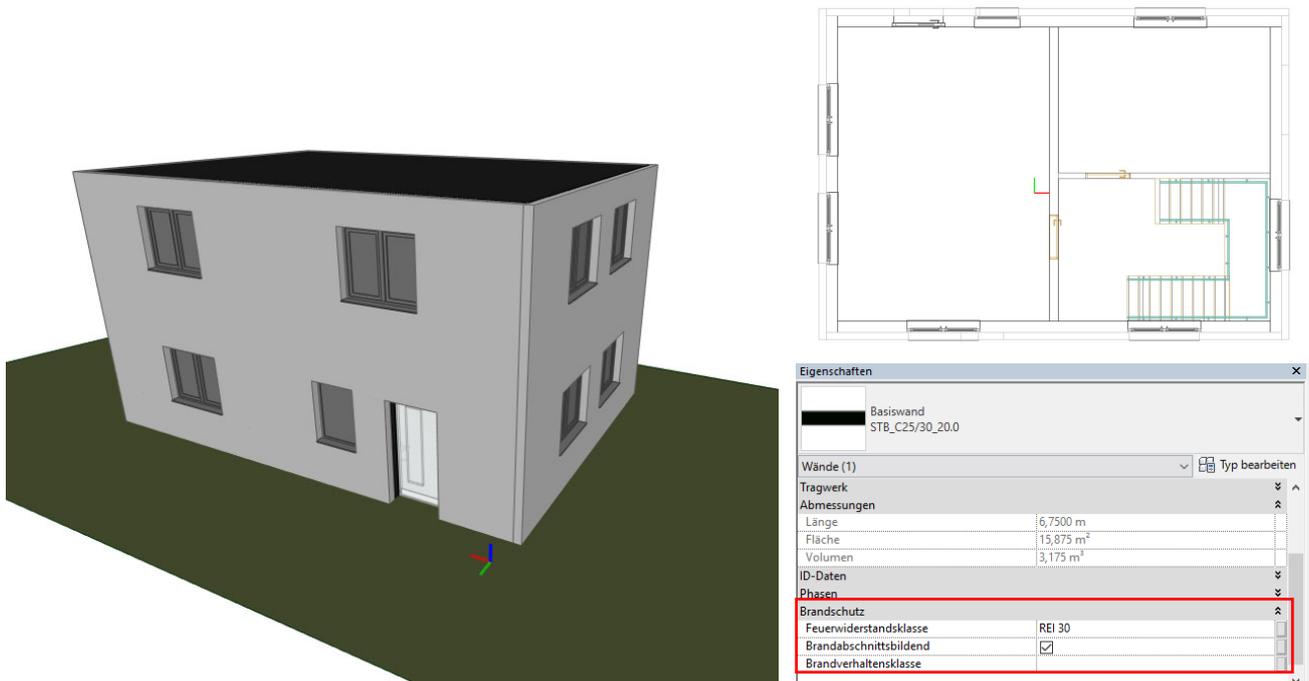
Vereinfachtes Modell mit Brandschutzparametern zur Evaluierung
